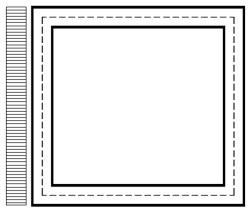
Schema tipo spinta carico accidentale su parete sinistra
